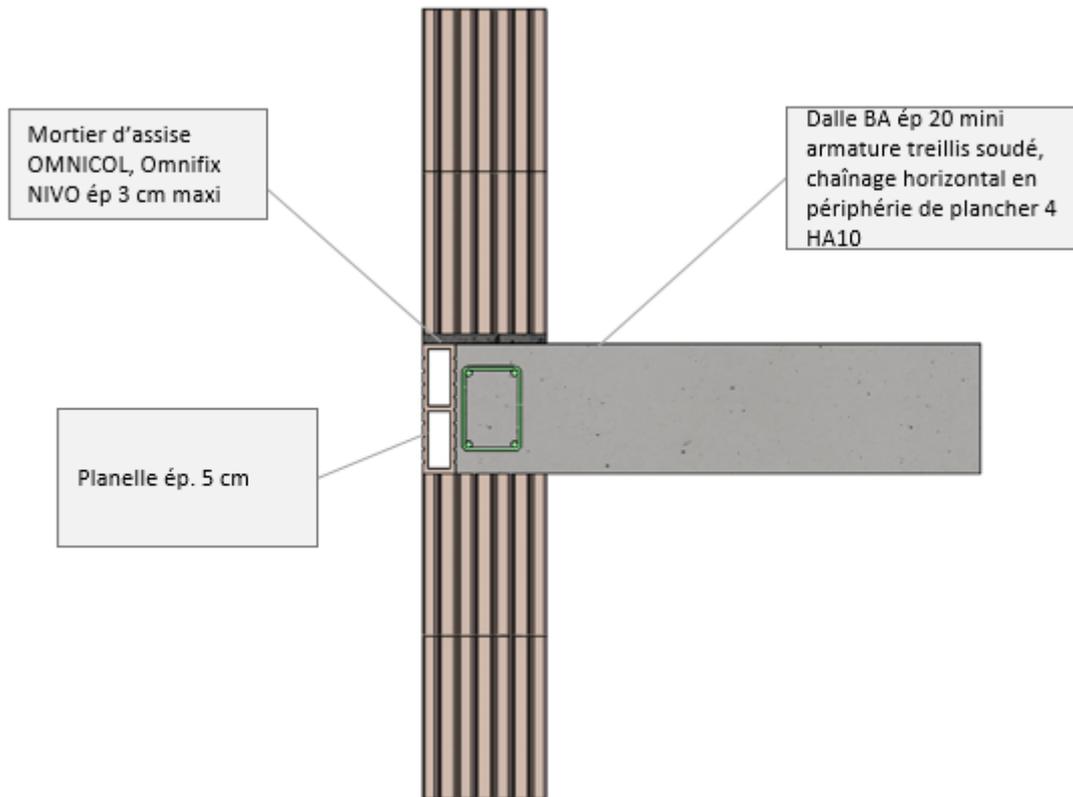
Détail coupe nez de plancher (hors zone sismique)
